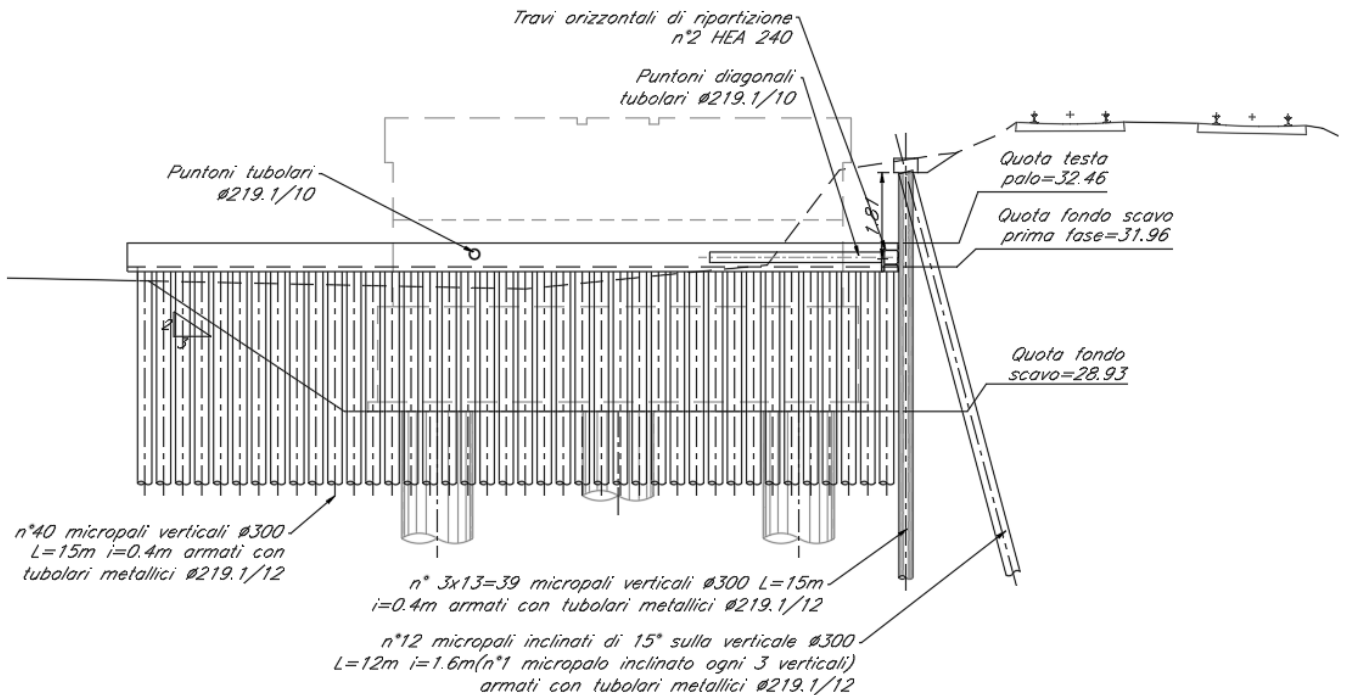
Sezione Opere Provvisionali Spalla B
